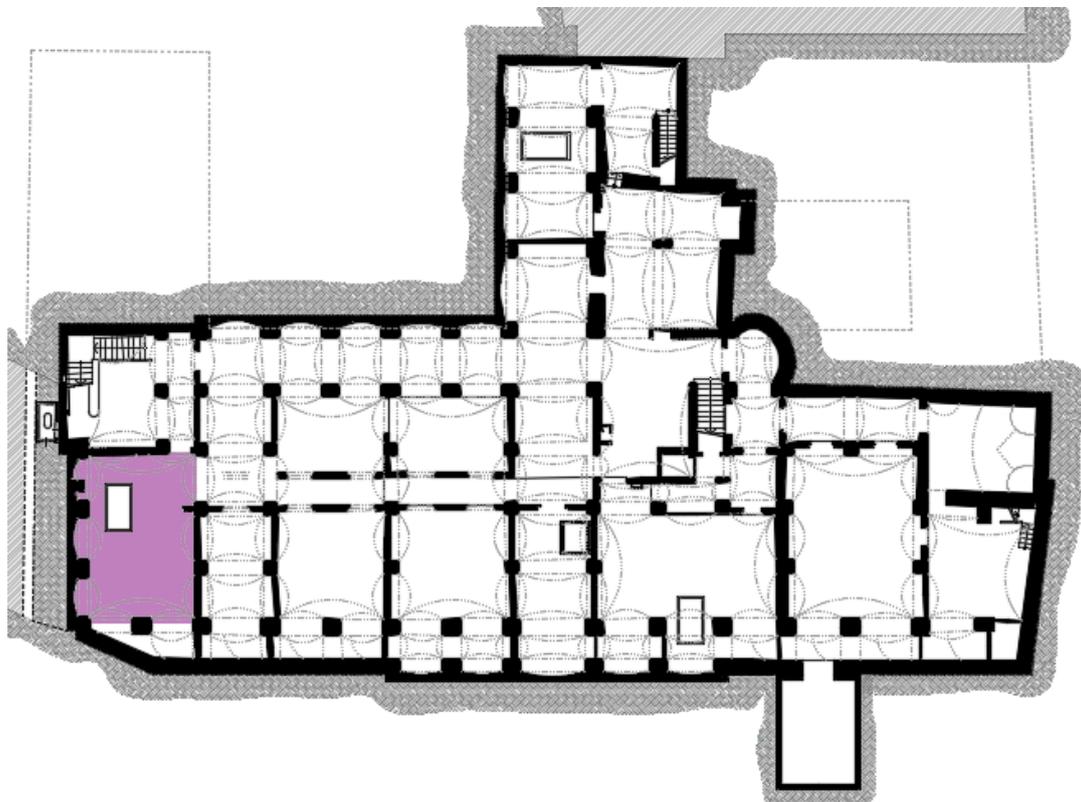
Pianta piano interrato. Area di distribuzione della UTA 3.
